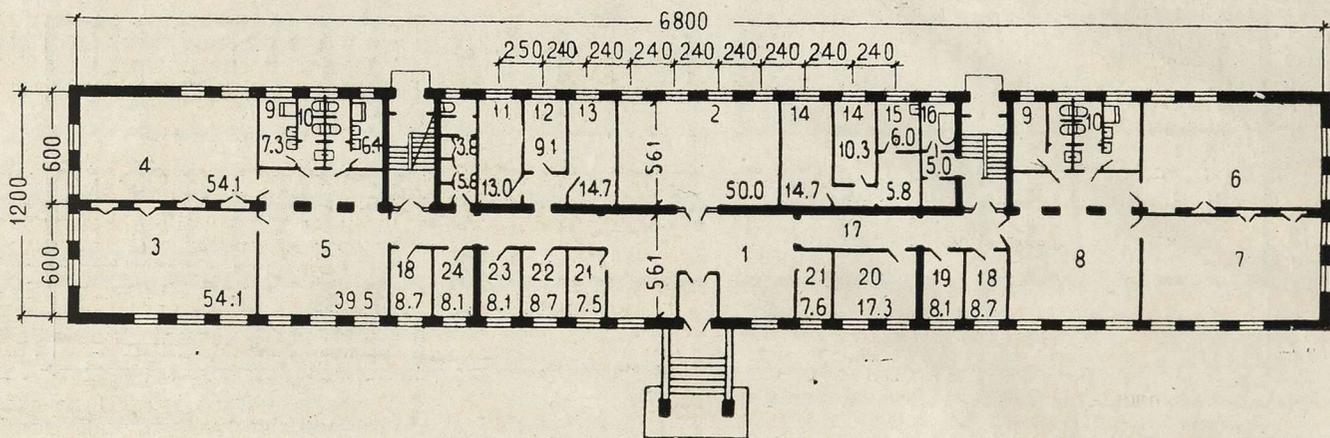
План секции типового этажа и подвала жилого корпуса на 300 мест
